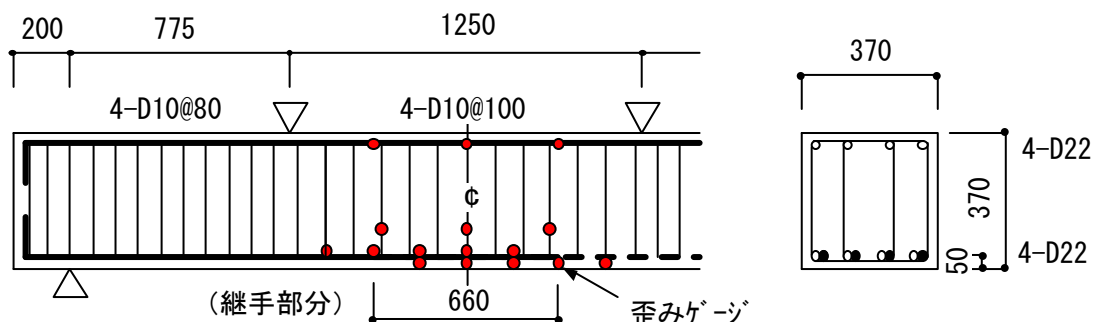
試験体の形状・寸法 (No. 4試験体の場合)
